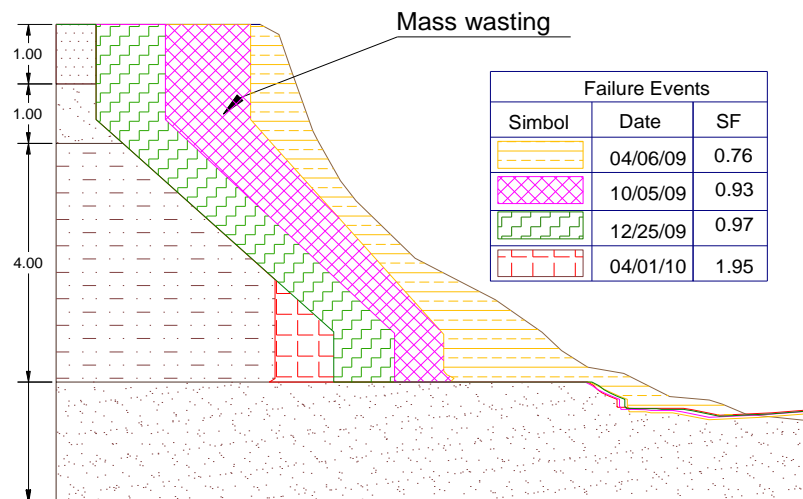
Principales fallas presentadas en el banco izquierdo de la sección 6
